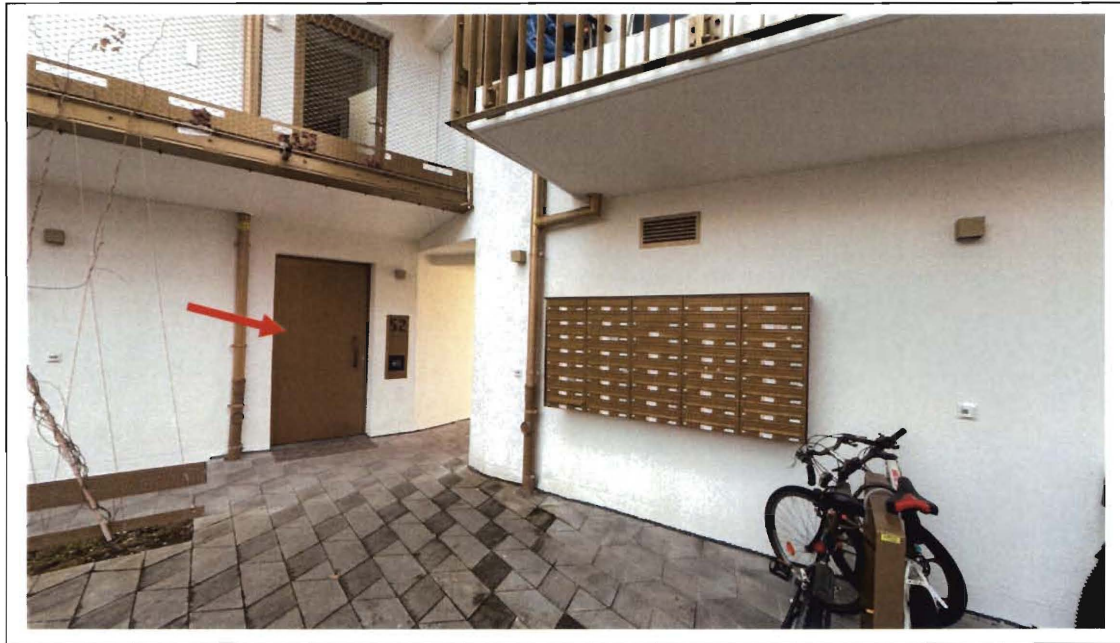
Hauseingangsbereich (Haus Nr. 52)
